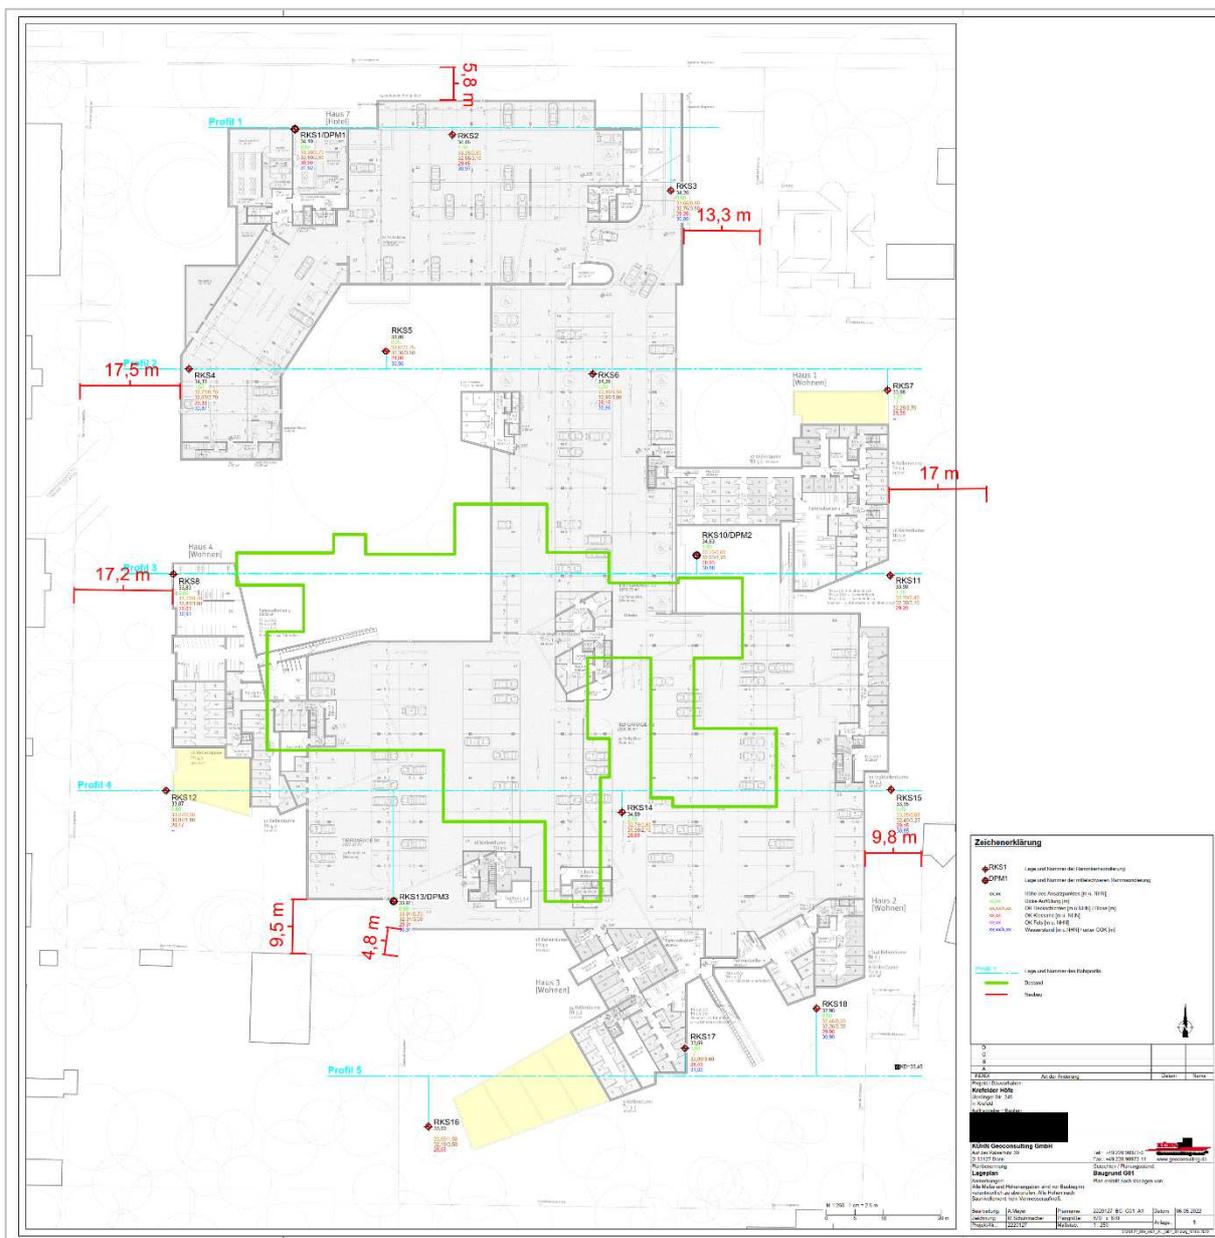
Lageplan mit ungefähren Abständen zwischen Neubau und Grundstücksgrenze
